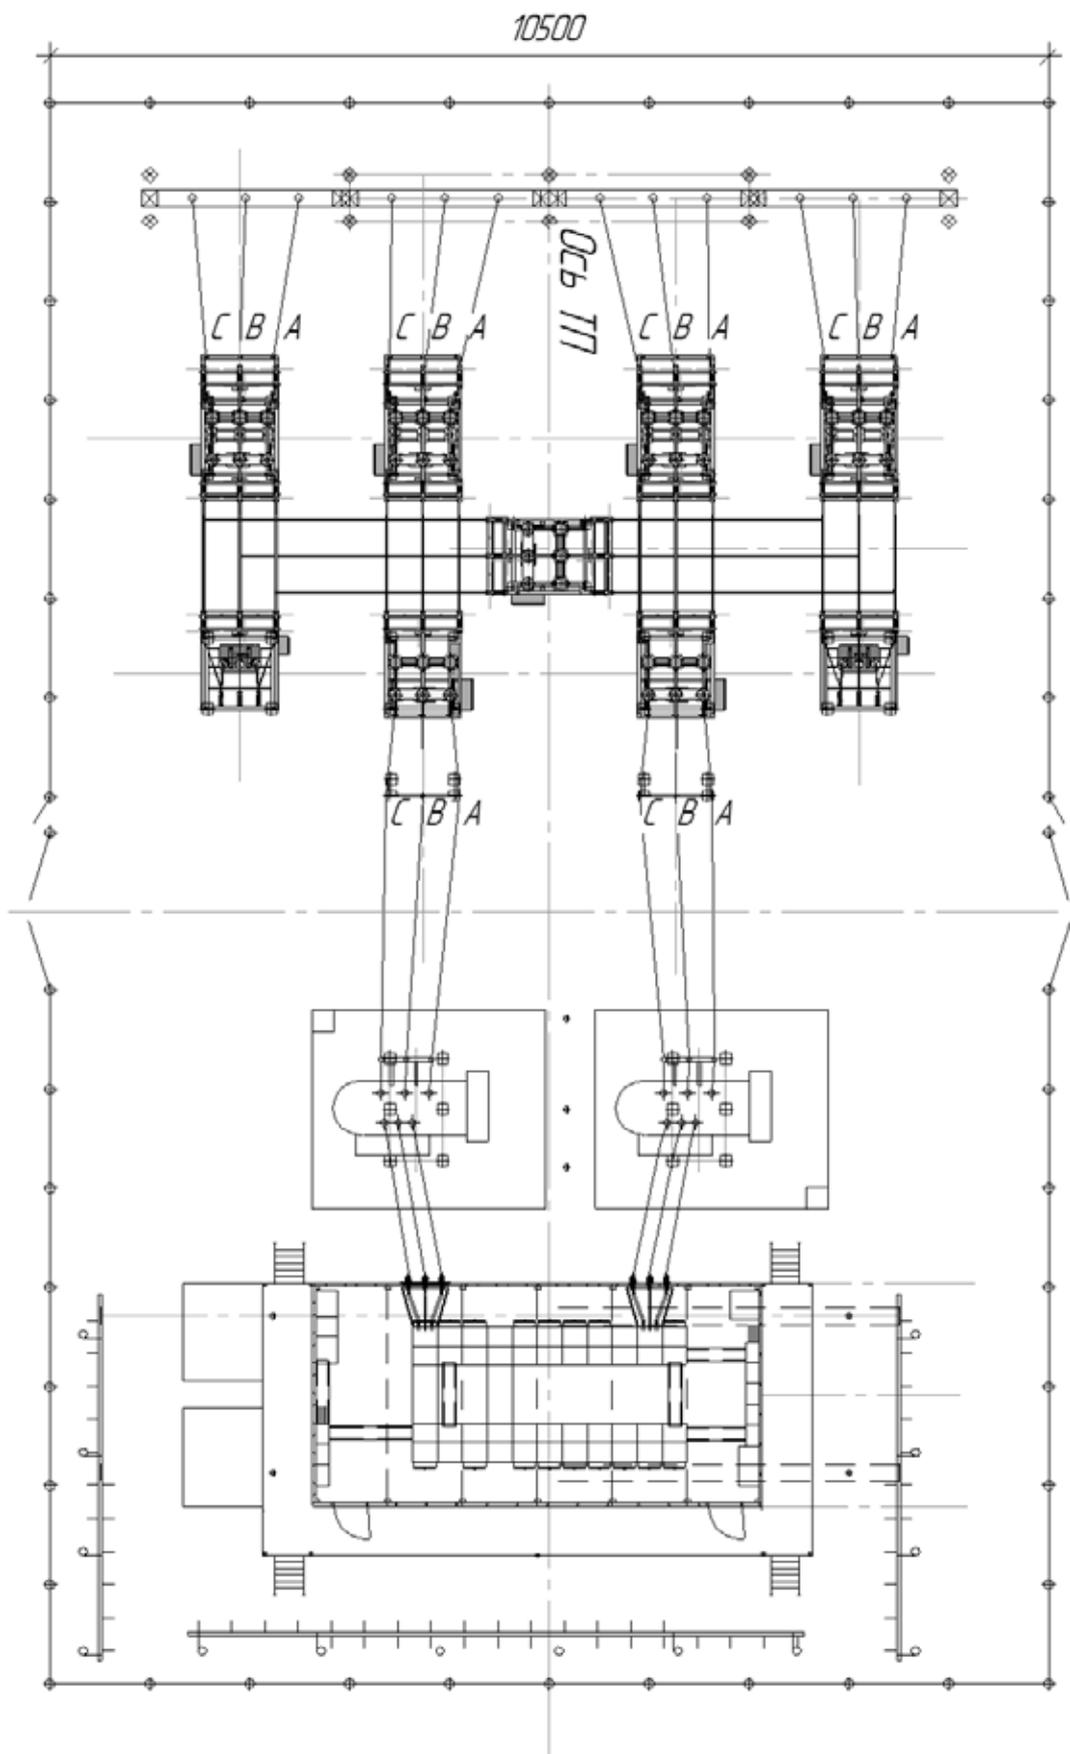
План подстанции 35 кВ по схеме 35-9Н.
